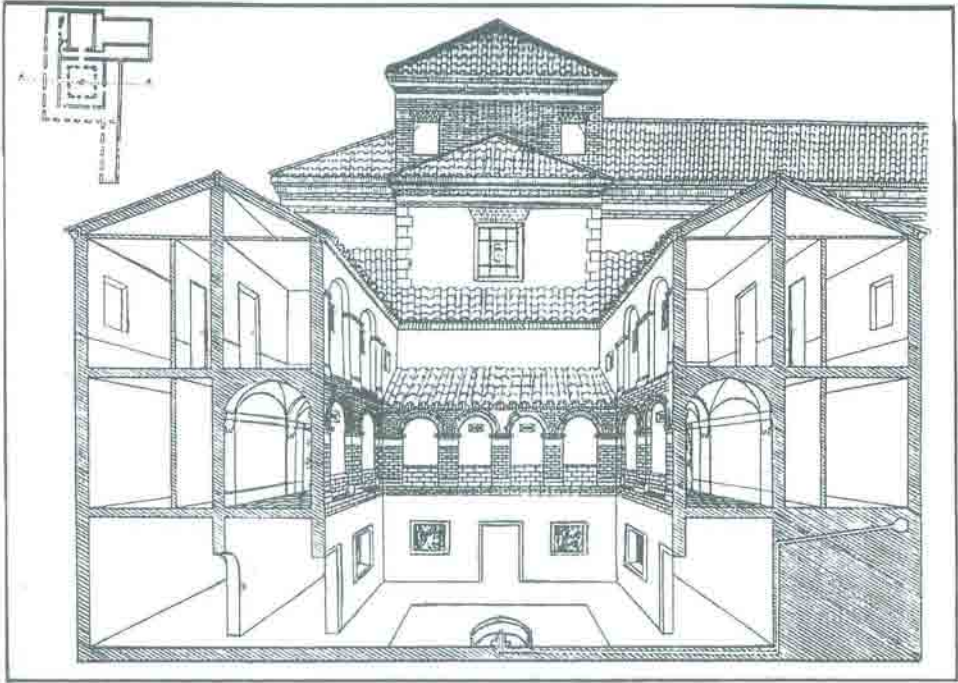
Dibujo esquemático de la estructura y disposición que, probablemente, tuvo el convento a la vista de lo que hoy queda del edificio. Sección con el corte por el centro en dirección norte-sur.
